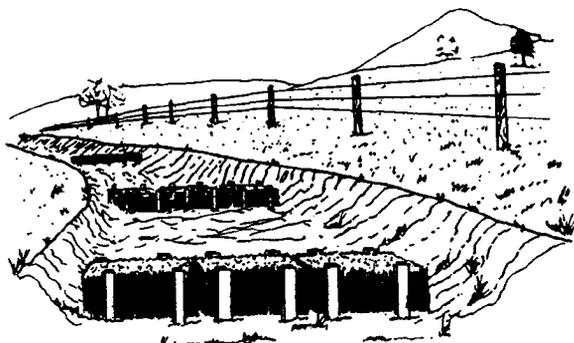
Zanjas de drenaje en una zona agrícola. Las balas de paja evitan la erosión y actúan de barrera de sedimentos.
